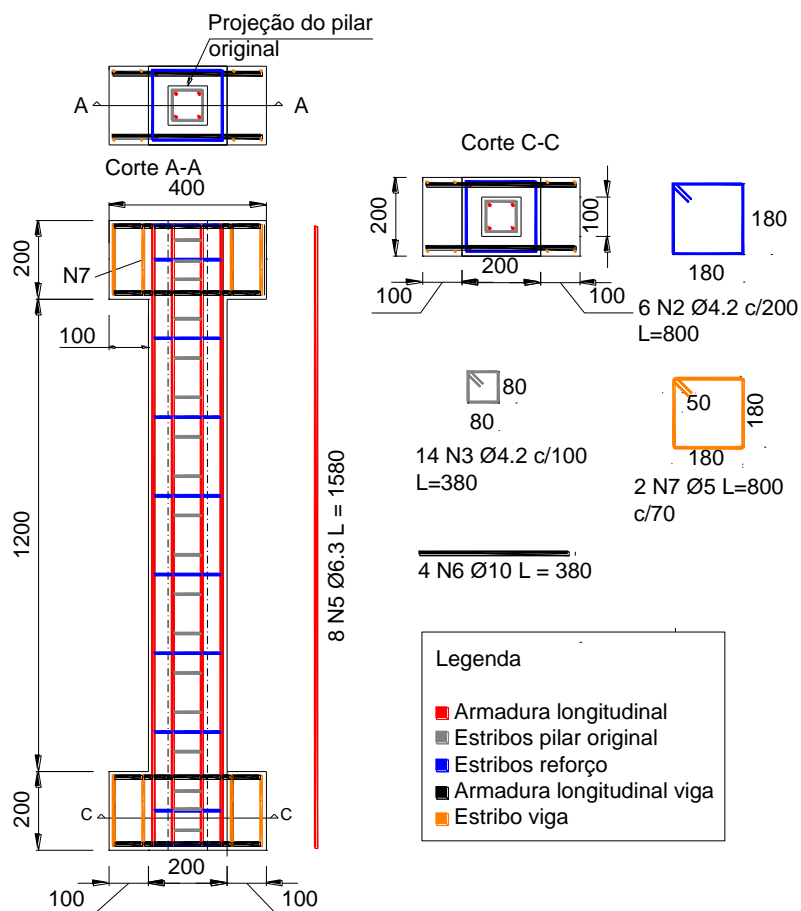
Detalhamento das armaduras dos pilares com trecho de viga
